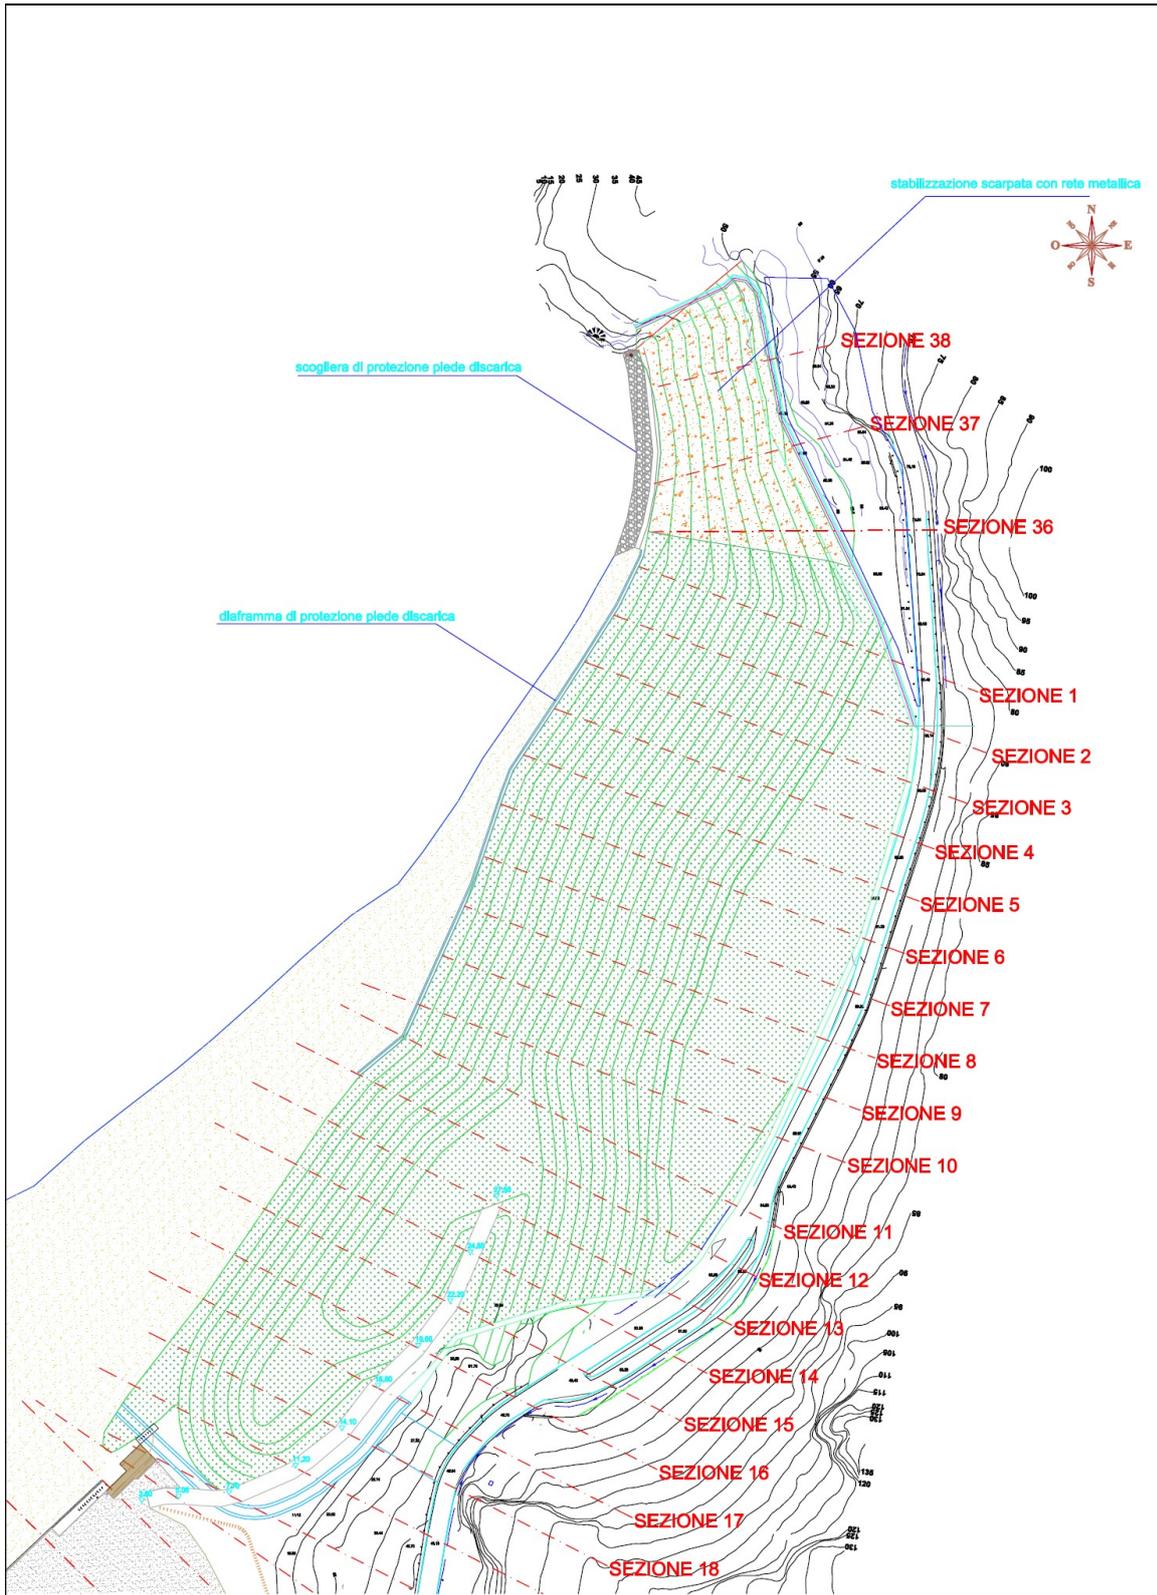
Planimetria dell'area della discarica con la rappresentazione delle opere in progetto
